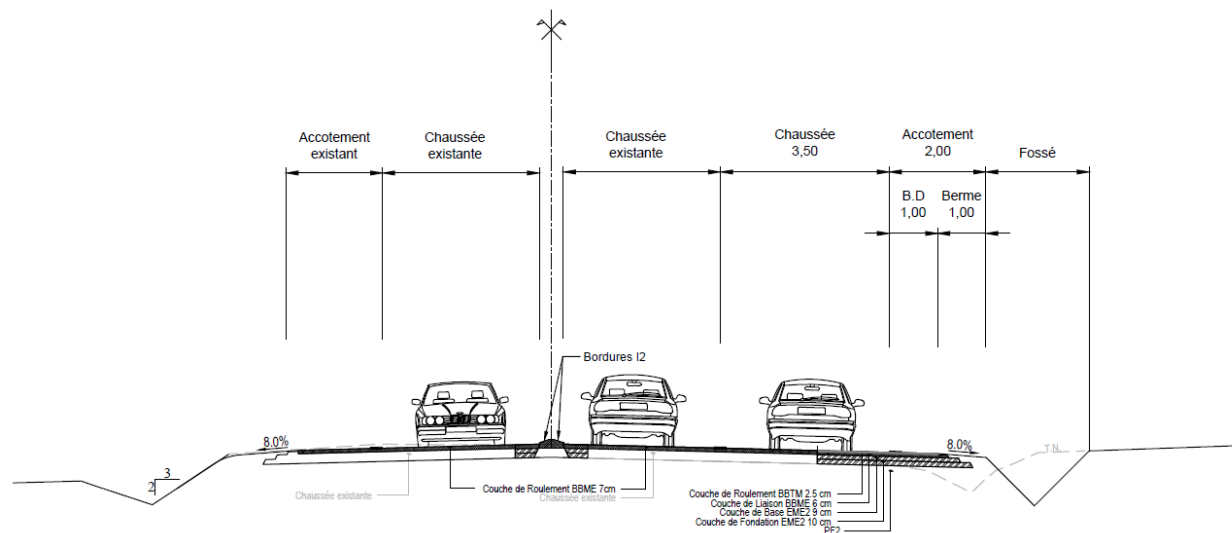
Profil en Travers Type de la RD9 au Nord de l'échangeur (AVP)
